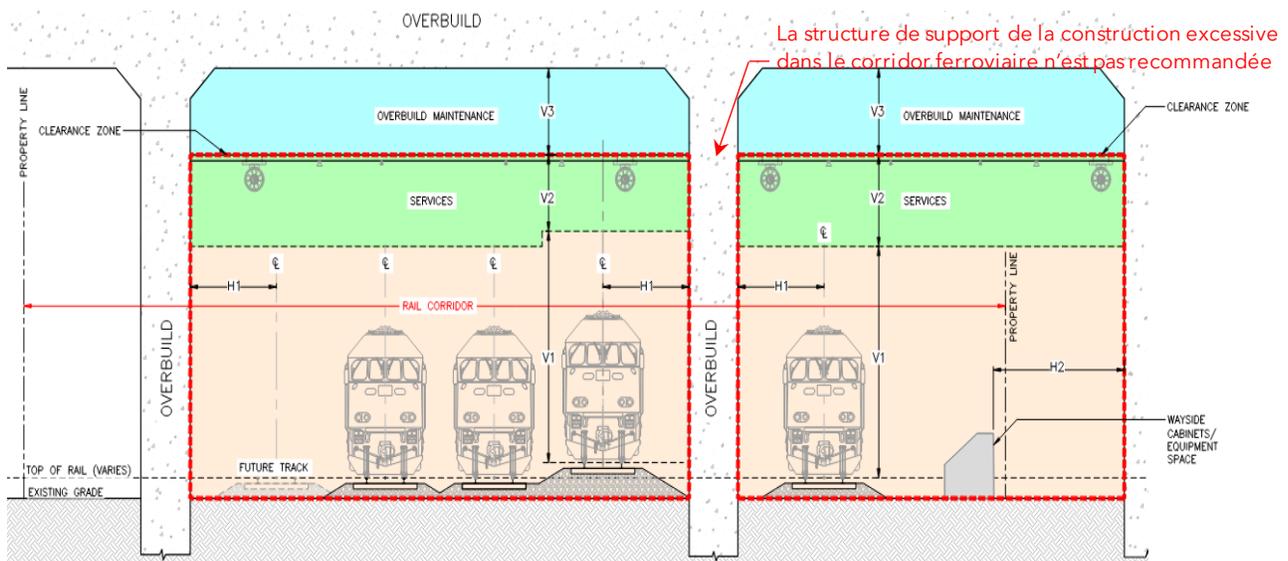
A Dégagements horizontaux et verticaux conceptuels de la construction excessive
